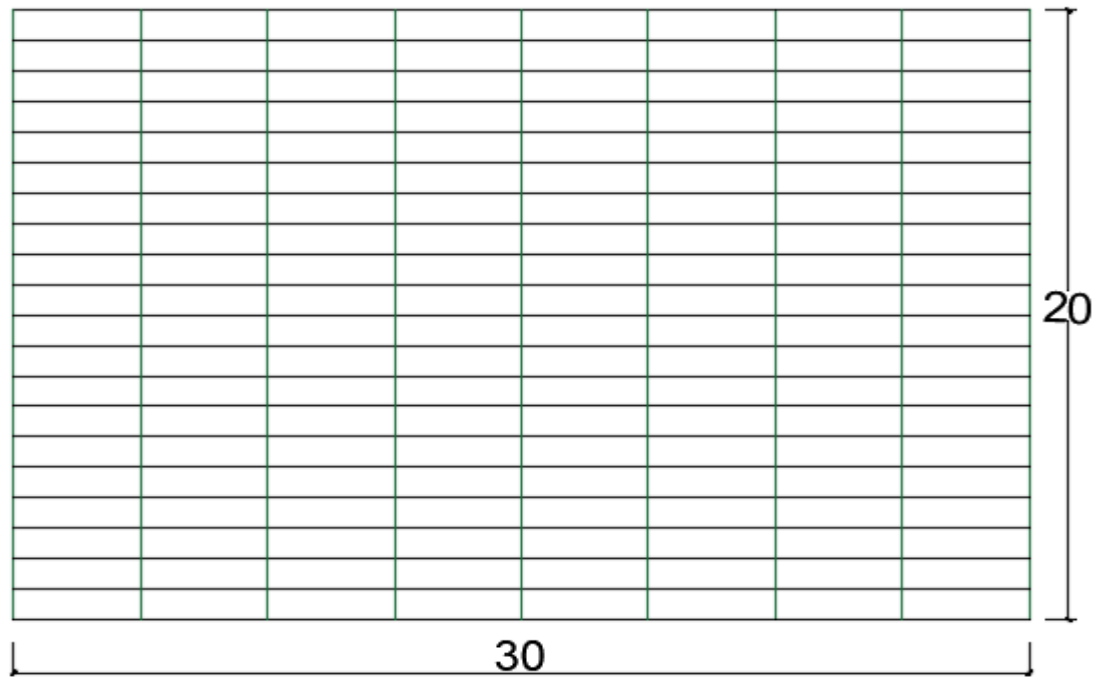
Vista en planta del Mercado Virgen de Fátima. Fuente: Elaboración Propia
